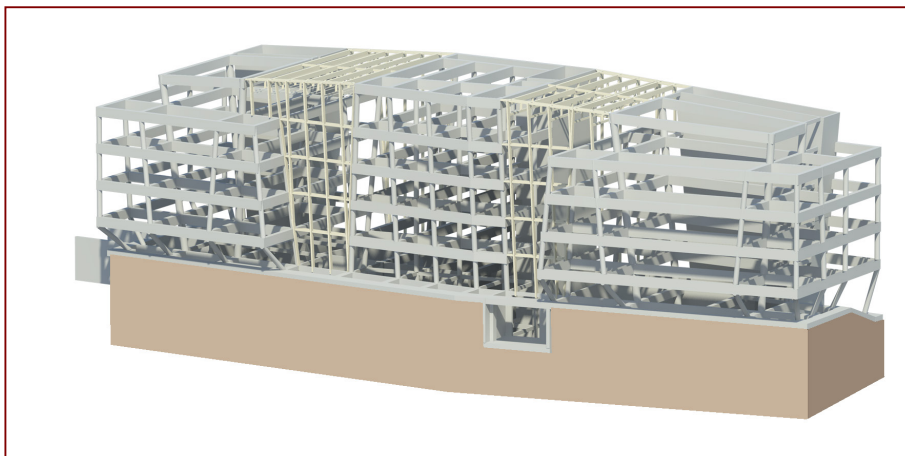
3D strutturale - Ricollegamento con struttura in legno.
